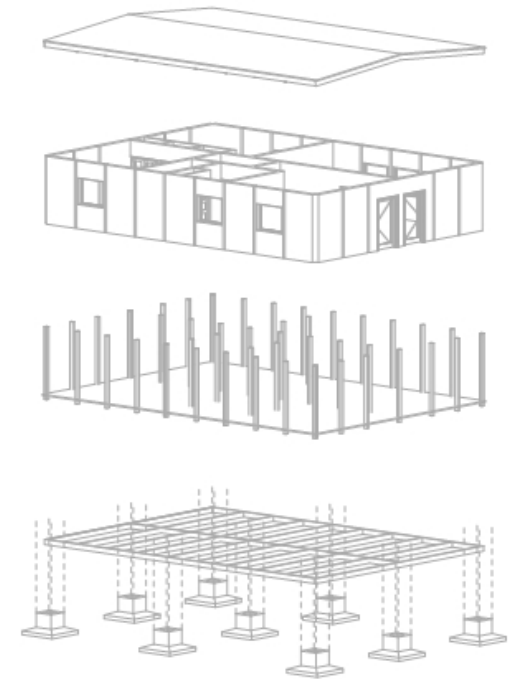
Gropius y Wachsmann, Packaged house, vivienda tipo A, 1942
